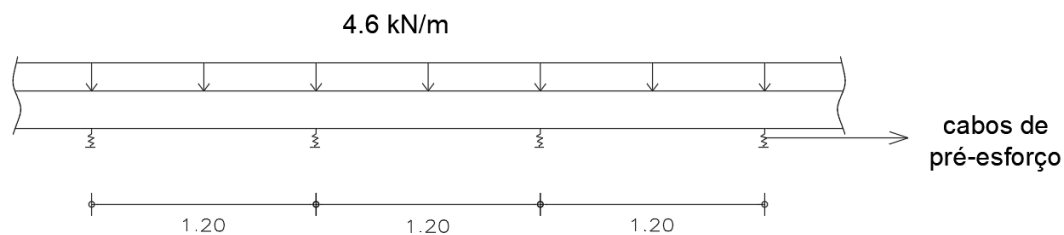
Modelo de viga contínua utilizado na análise da laje de cobertura para as cargas verticais.
